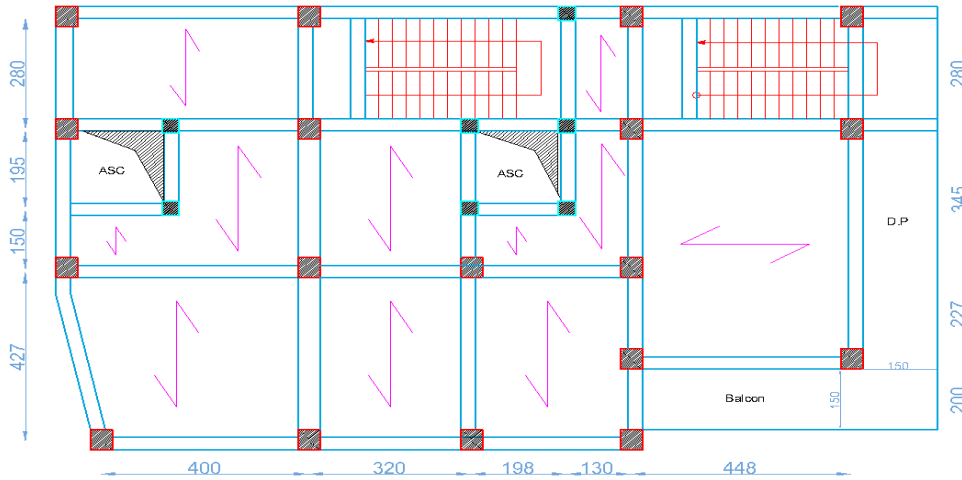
Figure II.I : Schéma de la disposition des poutrelles (étages : 1, 2, 3, et 4)
